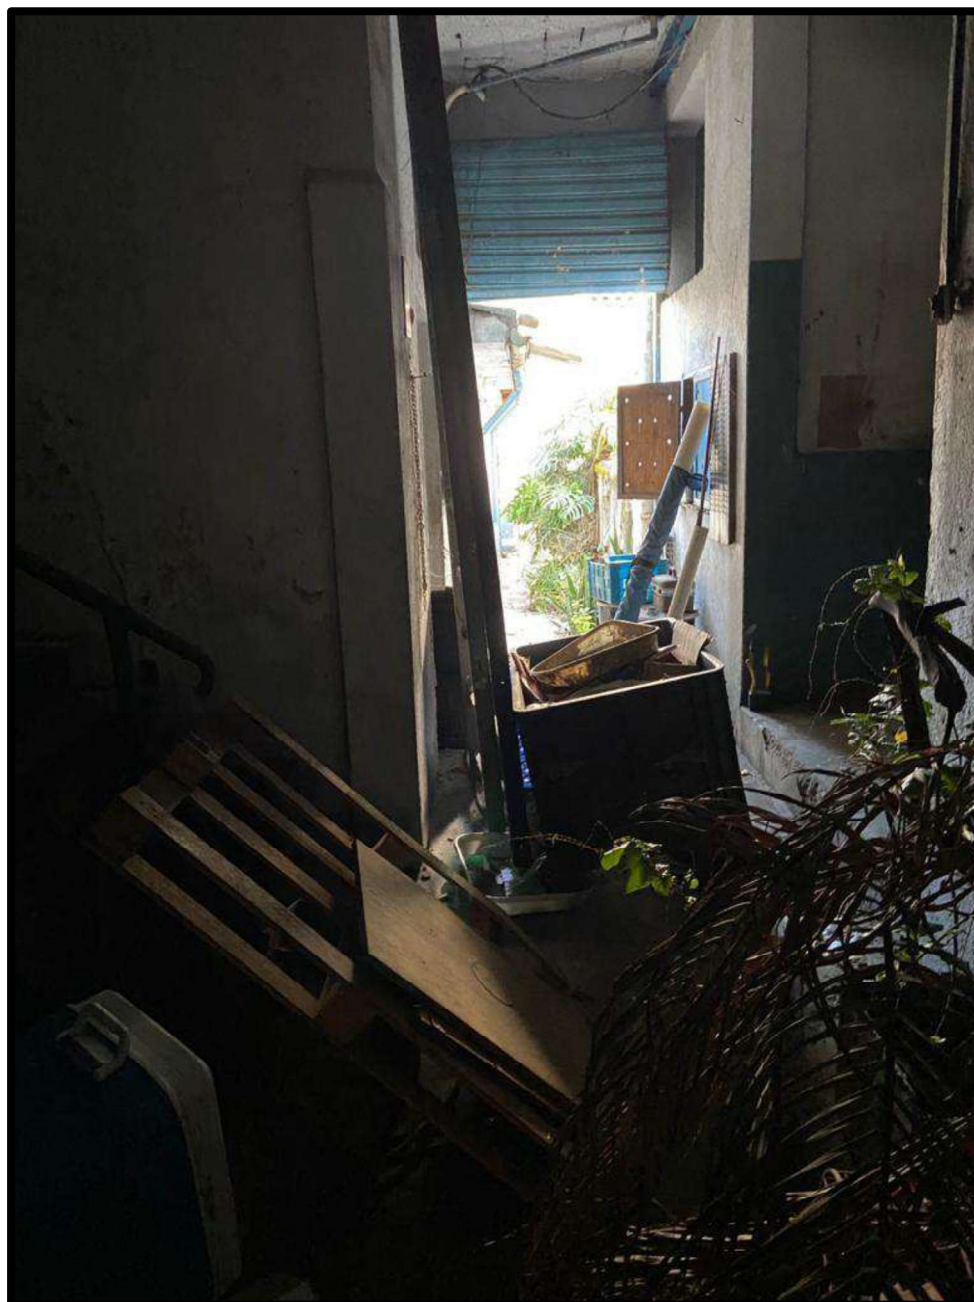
Vista da porta de entrada para a edificação localizada na porção de fundos do imóvel.
